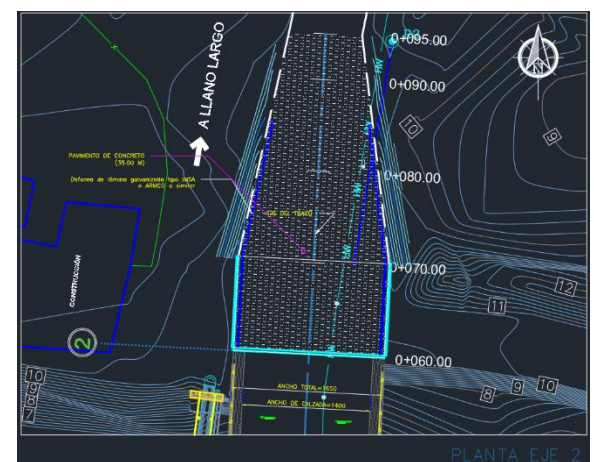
Vista de Elevación y Planta de las Rampas de Acceso del Puente Vehicular La Marquesita.
